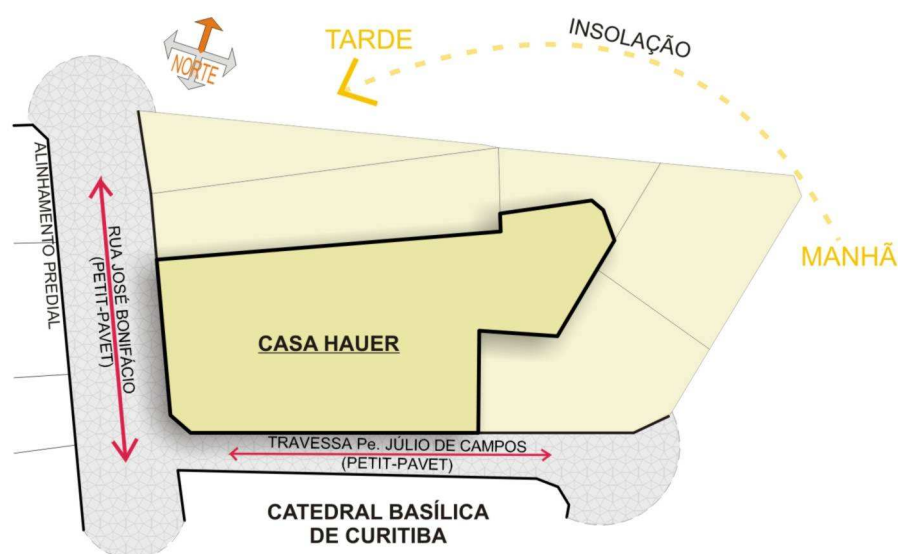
IMPLANTAÇÃO DO LOTE
